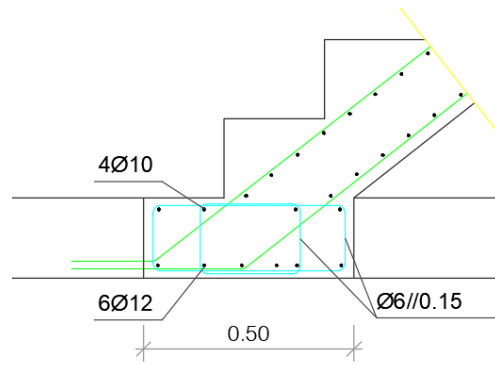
Pormenor de arranque de escada apoiada em laje (Projeto de estruturas).
